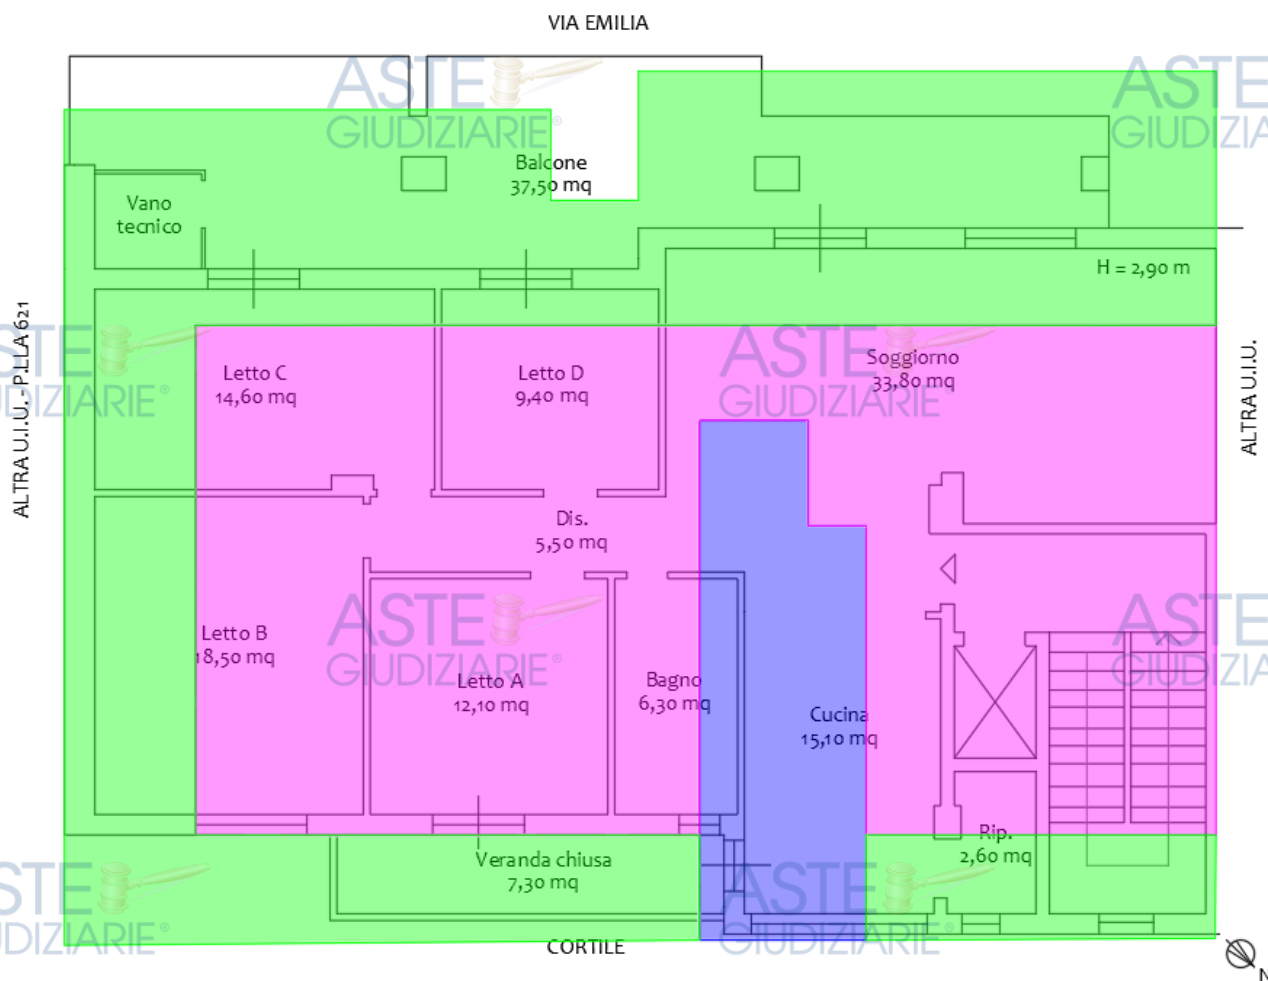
Sovrapposizione tra stato dei luoghi e planimetria assentita
